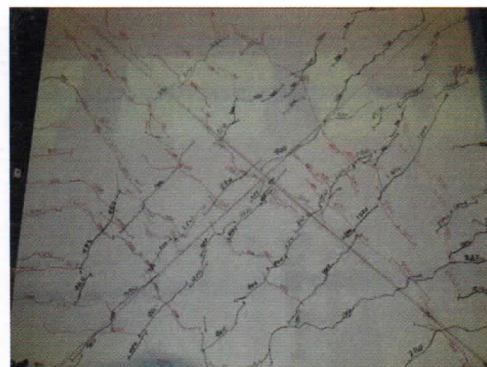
Continuación y nuevas grietas diagonales paralelo a la diagonal principal para una distorsión 1/400 Vista cara Norte.
